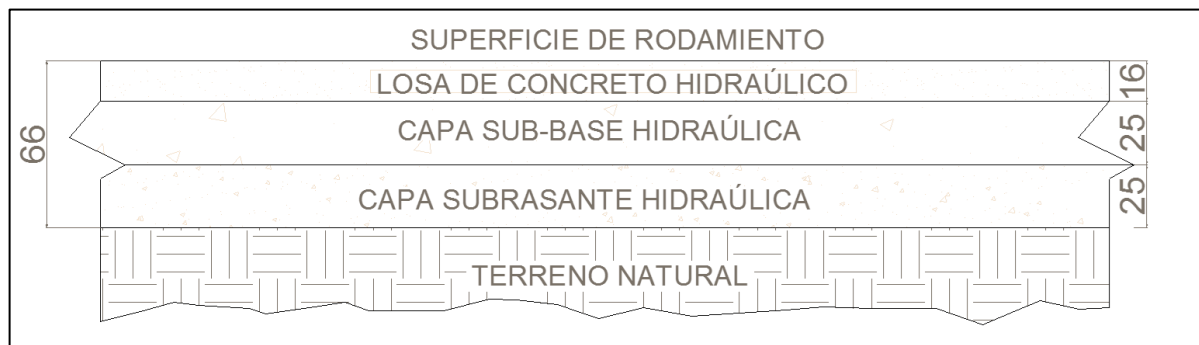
Estructura de Pavimento sin capa estabilizada.
